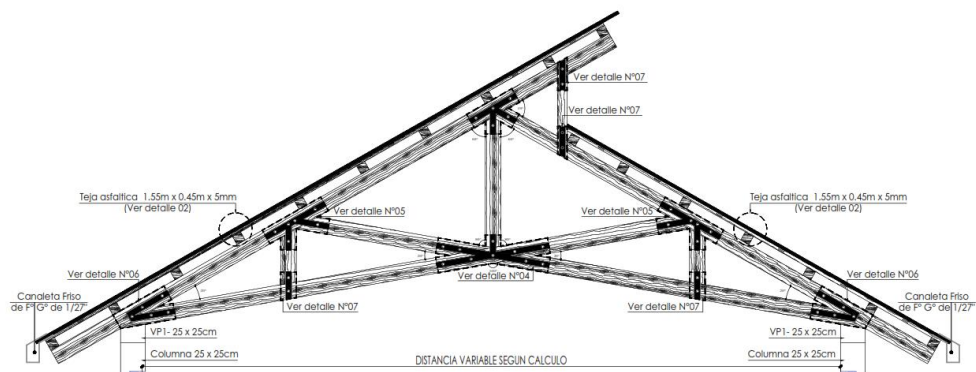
DETALLE TIPICO ESTRUCTURAL DE CERCHA
